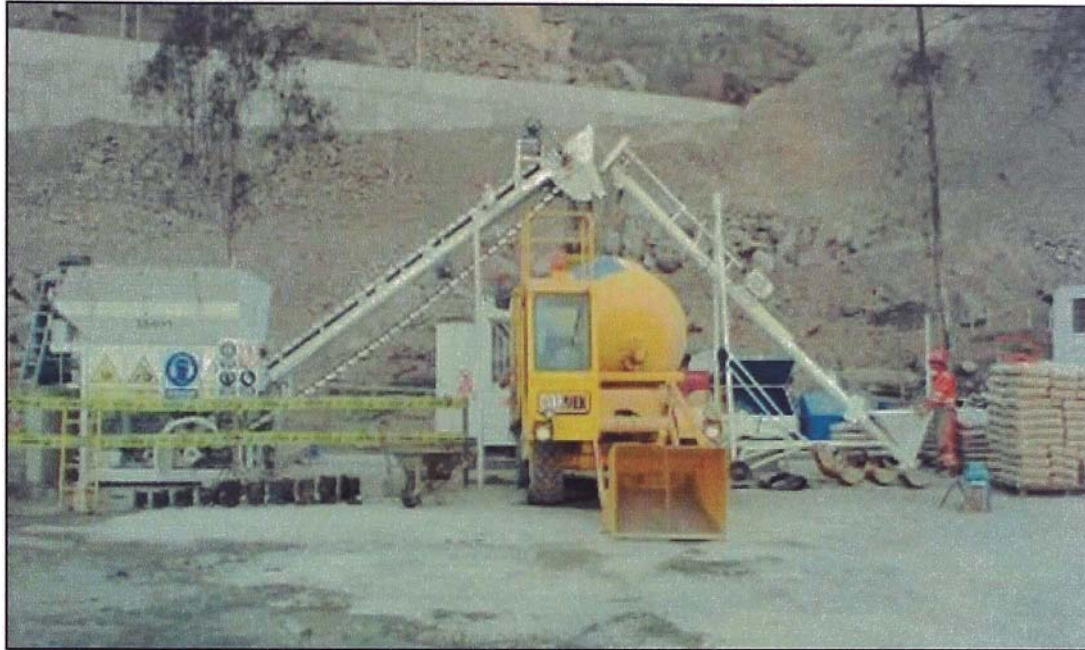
Fabricación de Paneles – Planta de concreto ODISA 2530
